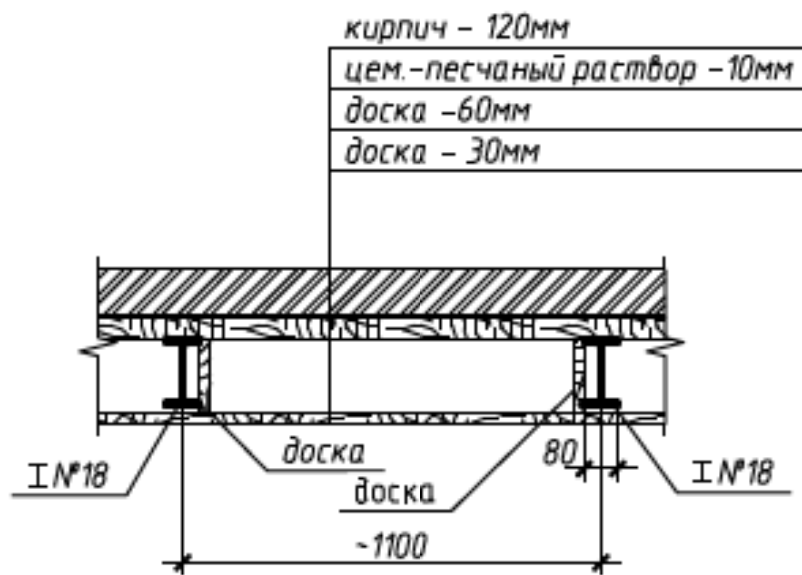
Вскрытие 2 (чердачное перекрытие)
